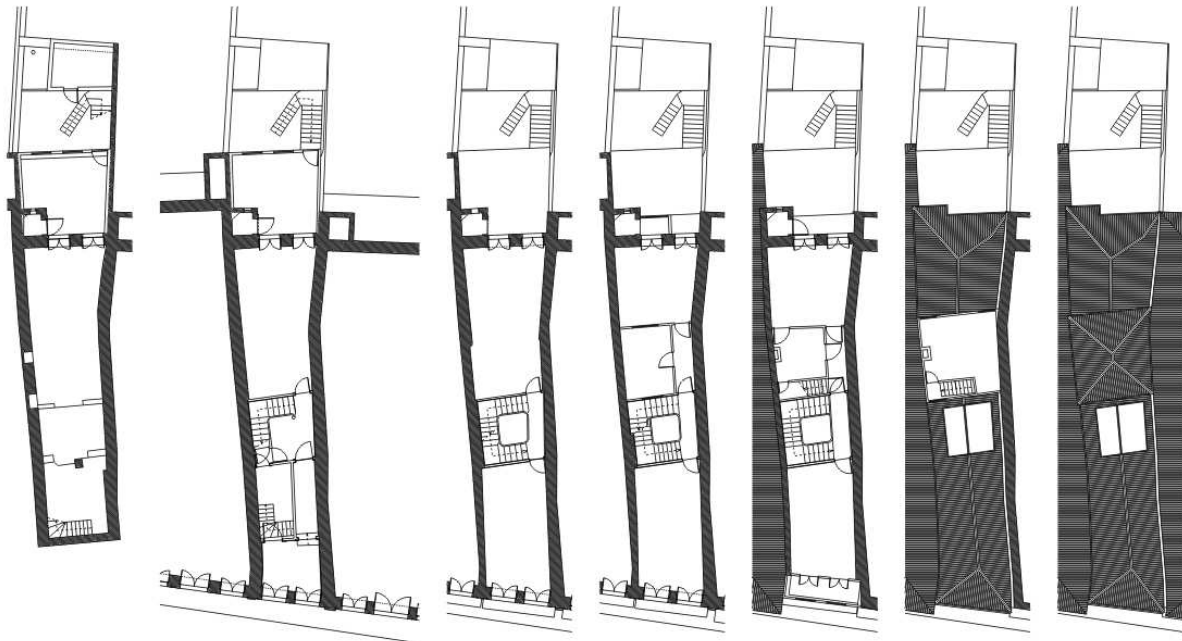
“Edificio existente: planes (Sur / Norte orientado)”.
